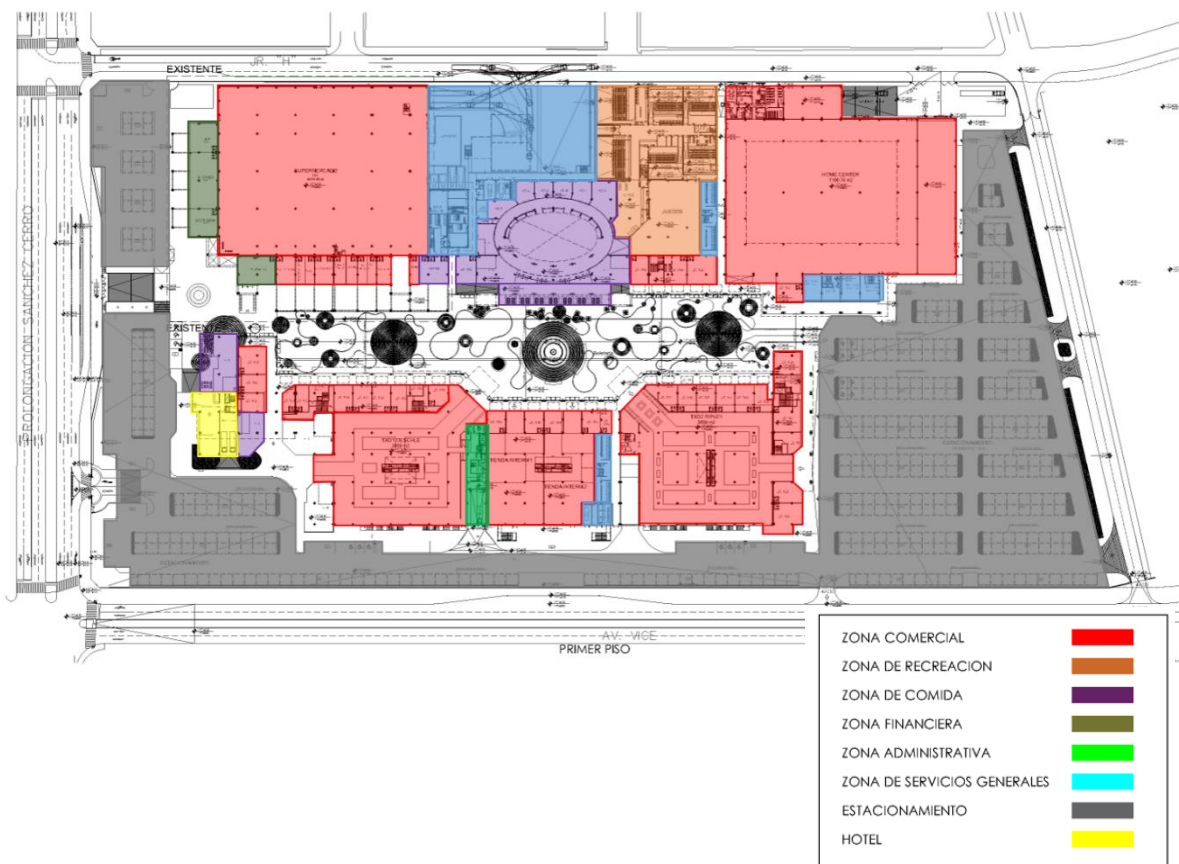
Plano de Distribución Primer Nivel del Centro Comercial Real Plaza Piura
